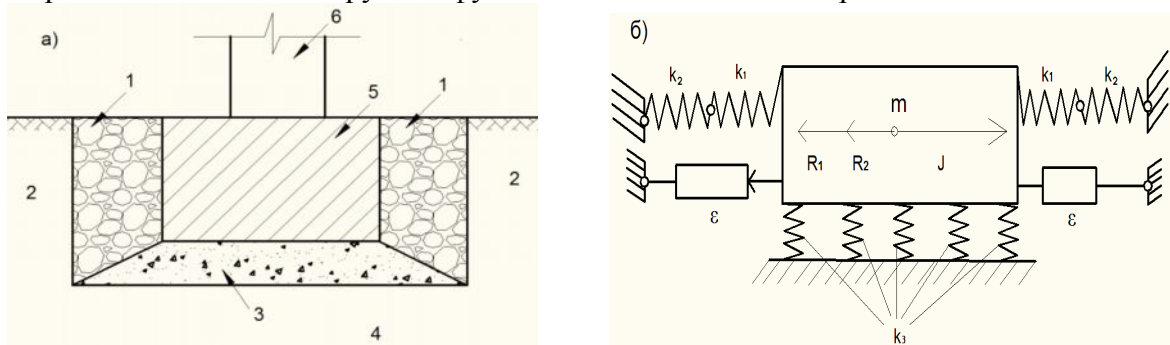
Конструкция фундамента с основанием и расчетная схема
